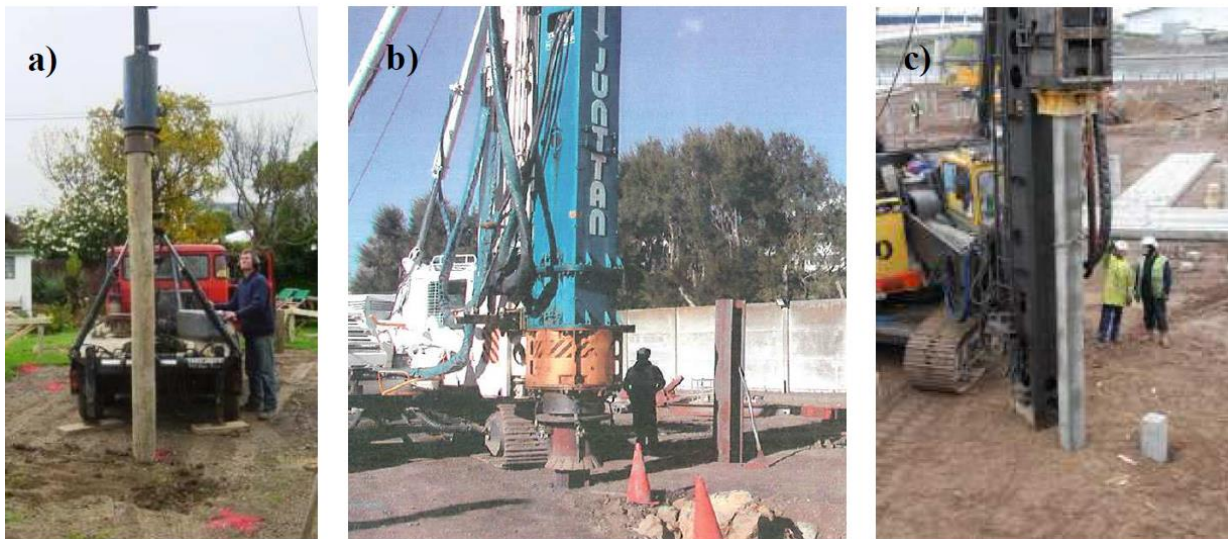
Inclusiones prefabricadas: a) de madera; b) metálicas y c) de concreto (Mánica, 2013)
